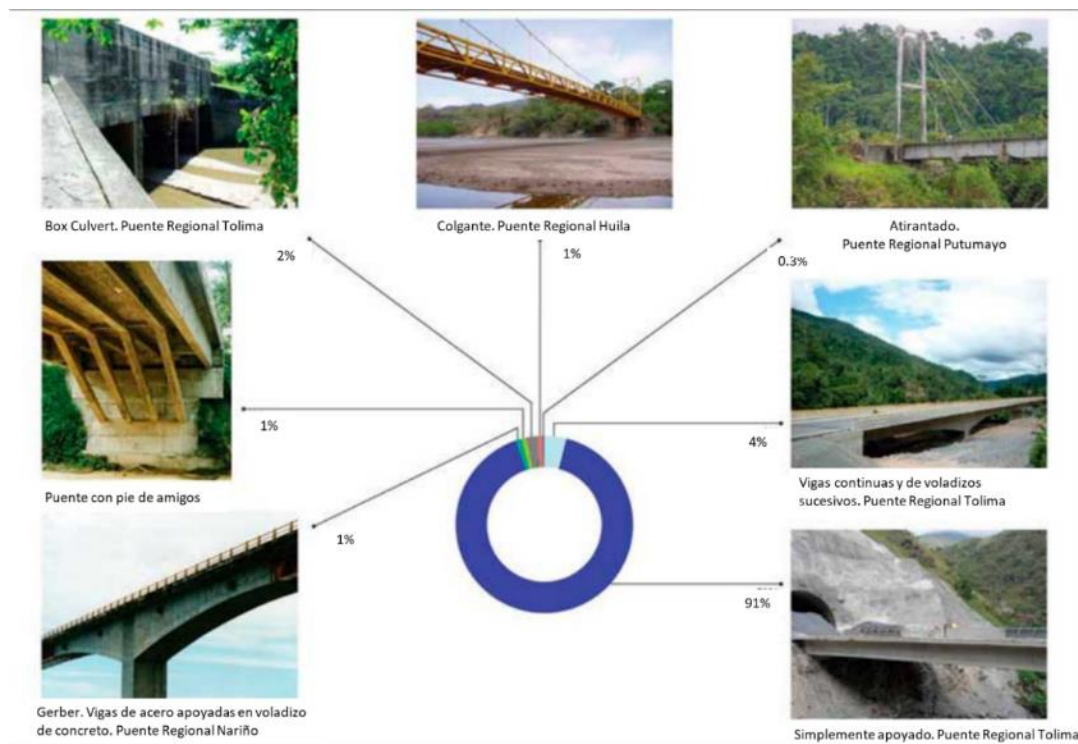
Distribución de las secciones longitudinales de la superestructura. Nota: En vigas continuas está el porcentaje de puentes en voladizos sucesivos.
